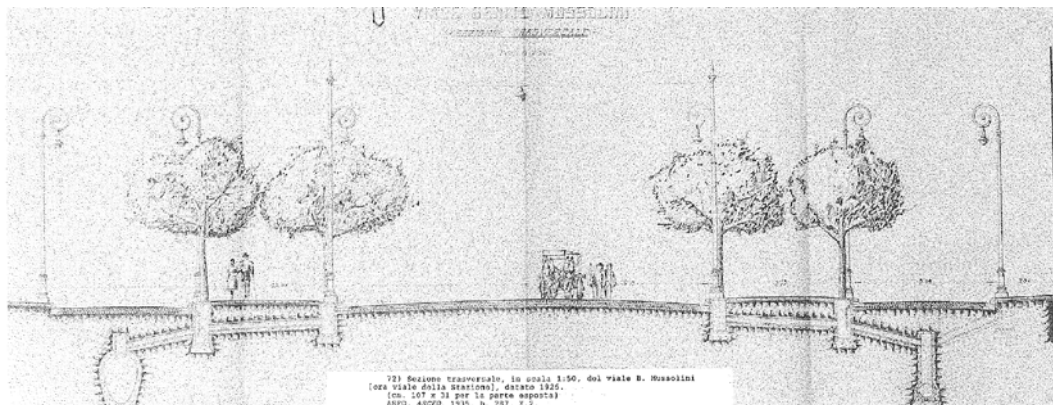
Viale Benito Mussolini, primo sezione trasversale della prima variante al progetto, 1926. Raccolta Archivio di Stato ⁽¹⁾
